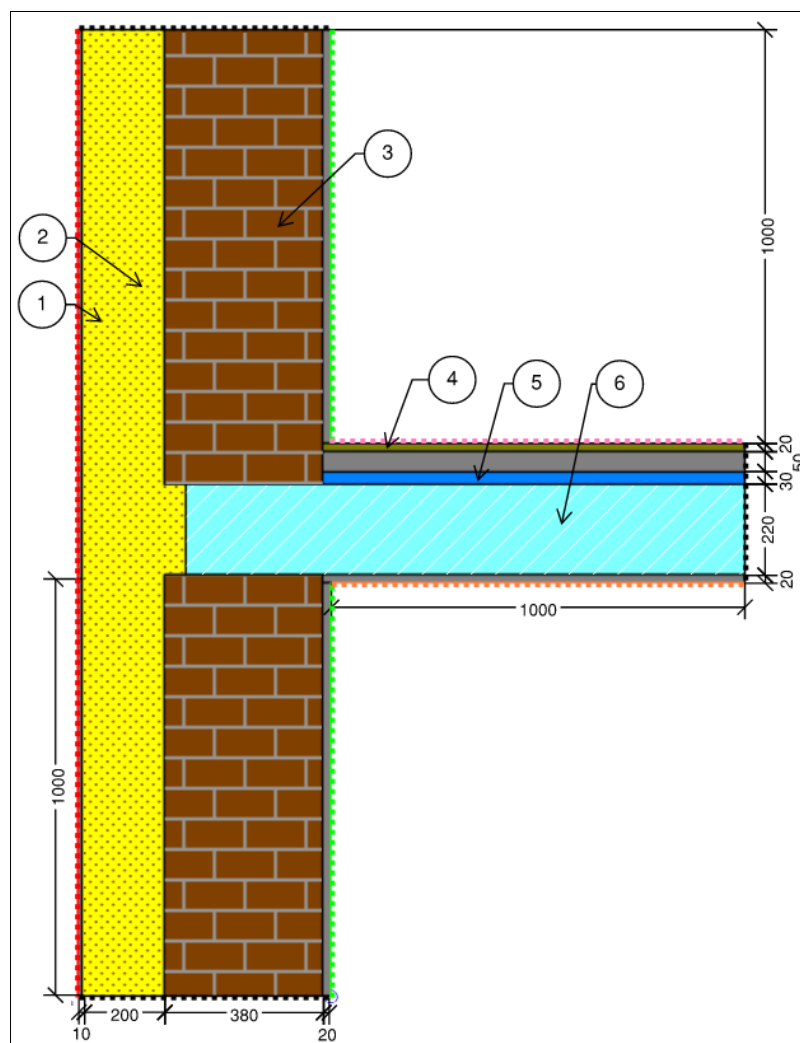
Схема покращеного вузла примикання зовнішніх стін до міжповерхового перекриття
